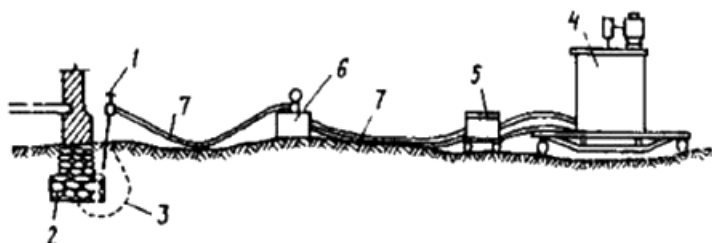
Схема усиления основания под существующими фундаментами способом цементации
